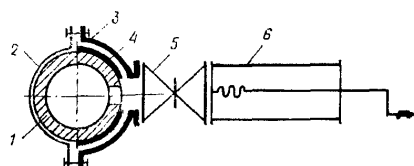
Схема устройства для присоединения ввода: 1 – труба наружного водопровода; 2 – хомут; 3 – седелка; 4 – прокладка уплотнительная; 5 – проходная задвижка; 6 – сверильное приспособление
